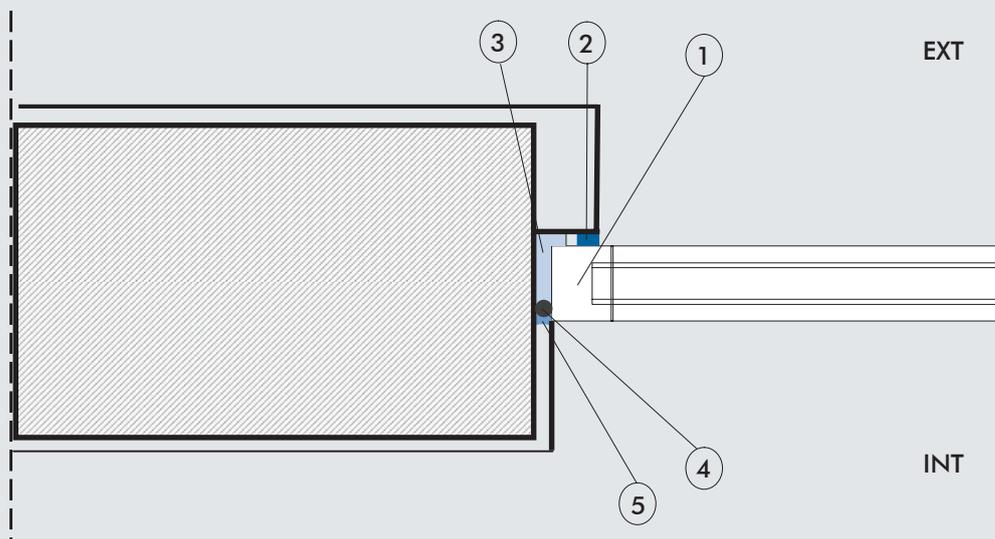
Cinta expansiva, espuma y sellador interior con fondo de junta (solapada)
